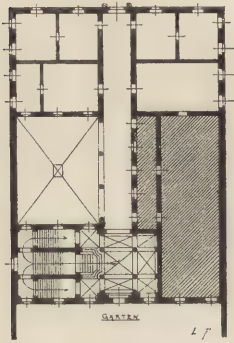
Palazzo Davia zu Bologna. Grundriss.
